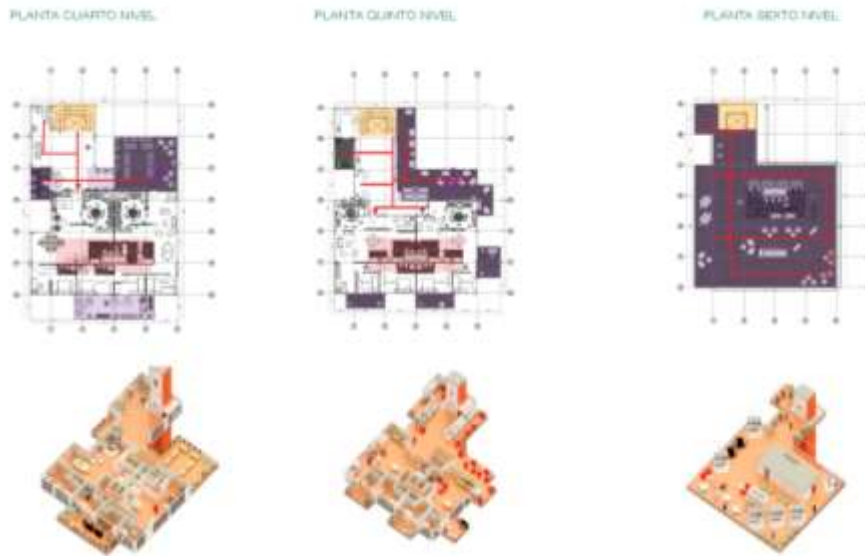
Propuesta de plantas 4, 5 6. Autoría propia (2020)
